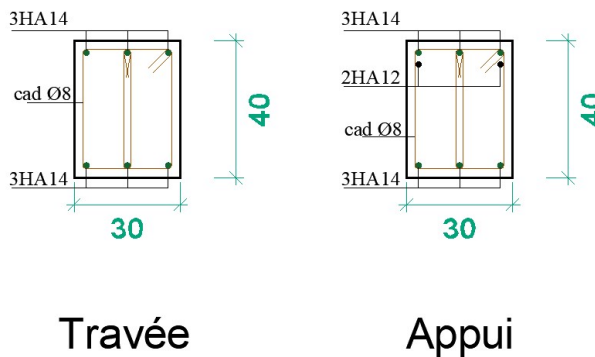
Schémas de ferrailage des Poutres secondaires.
